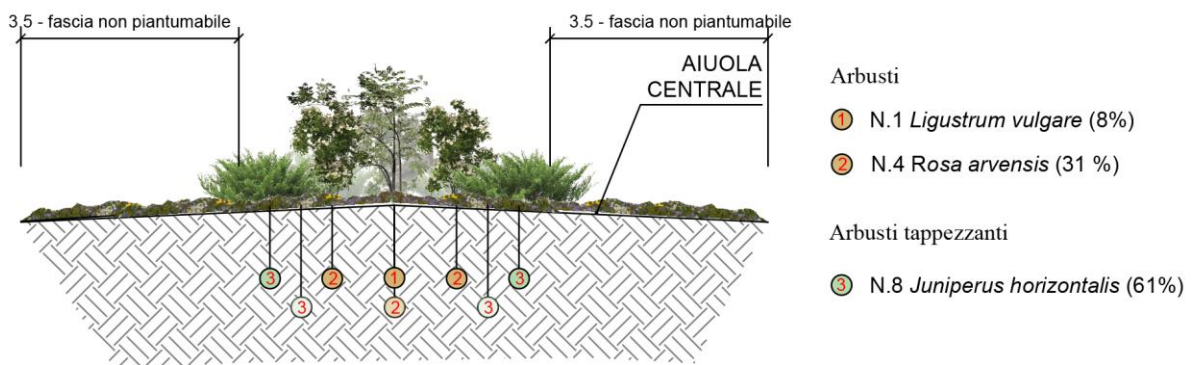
Prospetto piantagione rotatoria modulo PI-RO 3
